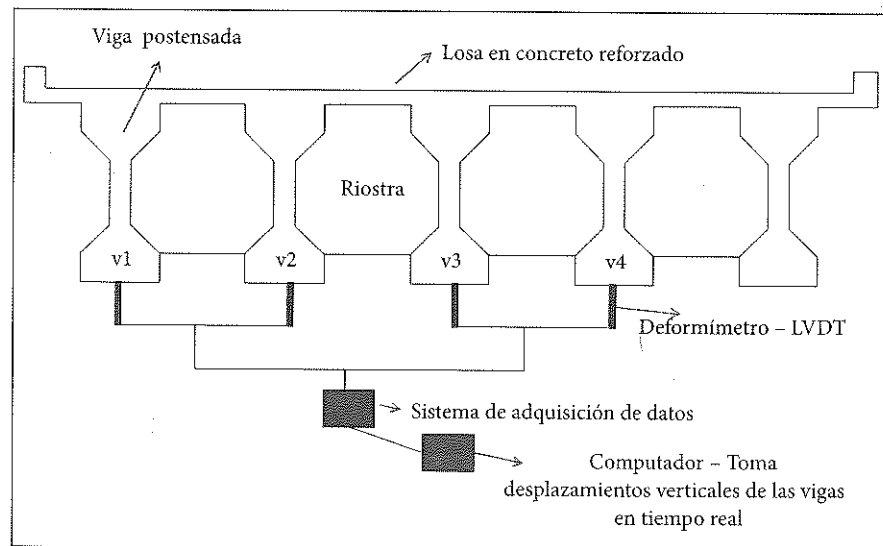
Esquema con la localización de los LVDT en las vigas del puente y el sistema de toma de datos.
